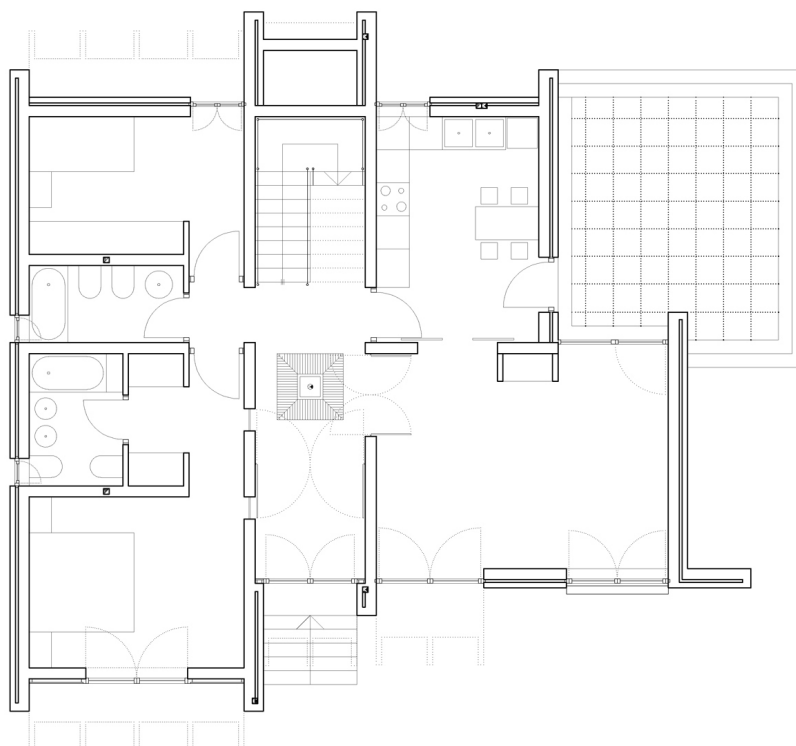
Planta piso 0, Tipologia D, Autor: Luis de Garrido Fonte: Cortesia de Luis de Garrido ARCHITECTS
